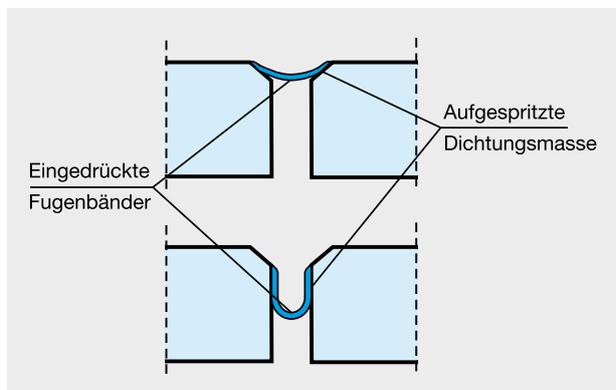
Fugendichtung mit aufgeklebten Bändern
